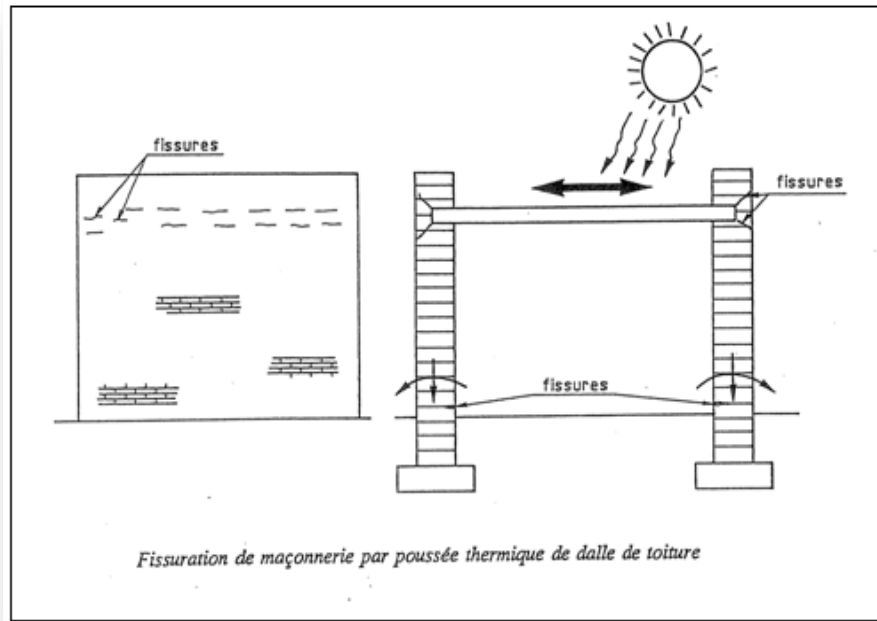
fissuration de maçonnerie par poussée de dalle de toiture.
